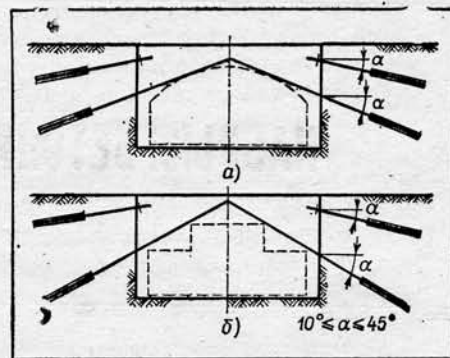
Устройства анкерного крепления котлованов, обеспечивающие демонтаж анкеров:
